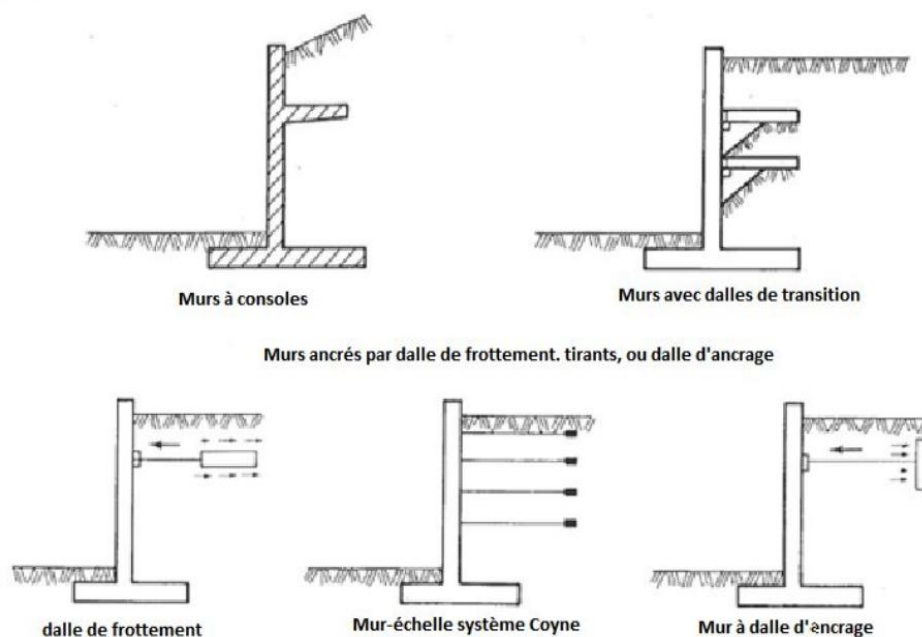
Schéma de divers murs de soutènement en béton armé [2]
